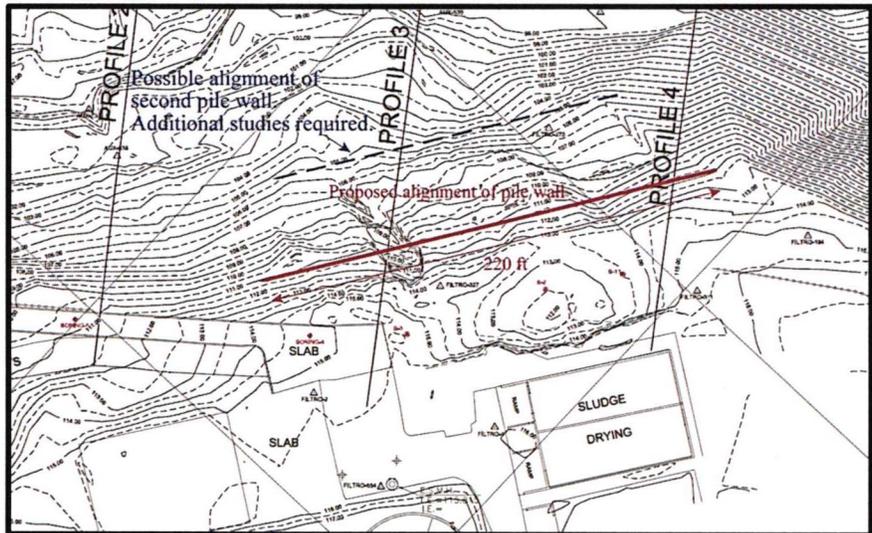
Localización propuesta del muro de pilotes y posible ubicación del segundo muro de pilotes para remediar la mitad inferior del deslizamiento de tierra.
